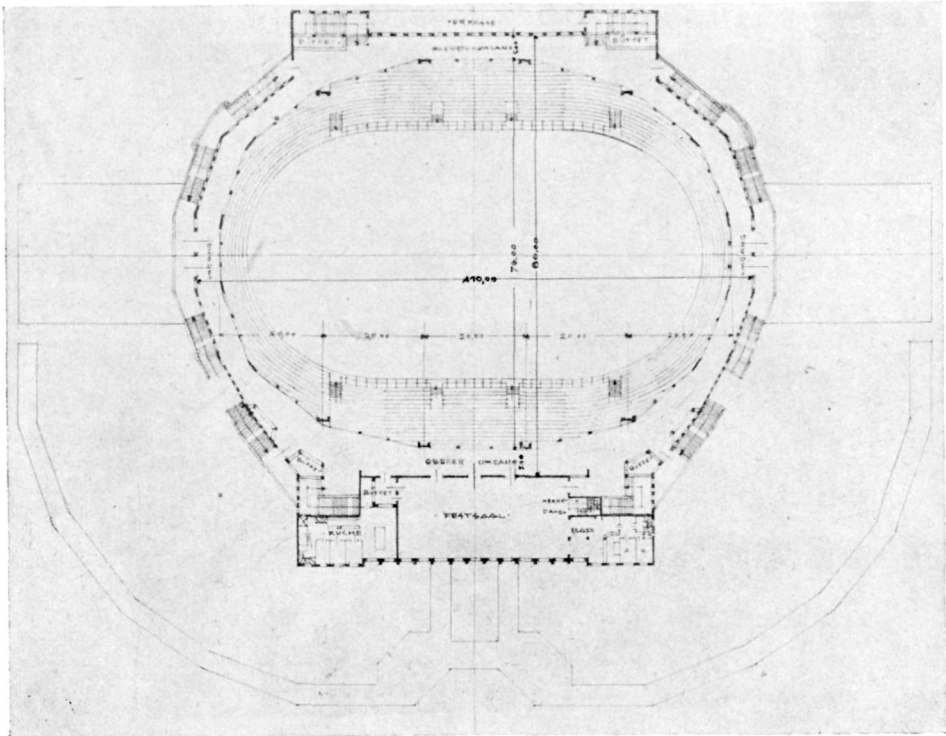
Westfalenhalle Dortmund. Obergeschoß-Grundriß 1:500
